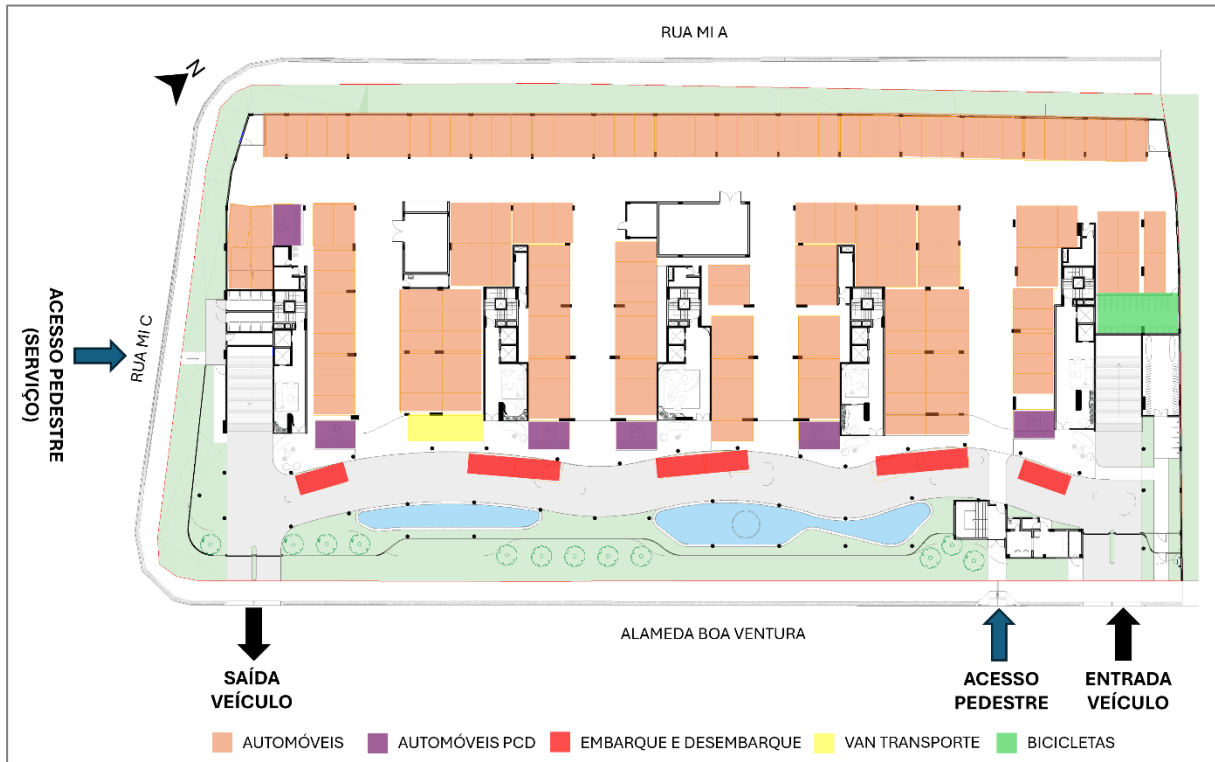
Planta esquemática do pavimento térreo com indicação da localização e tipos de vagas e acessos.
